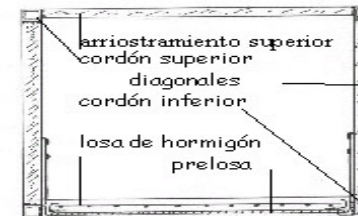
Sección transversal tipo. Ingrid Raventós (2000).
